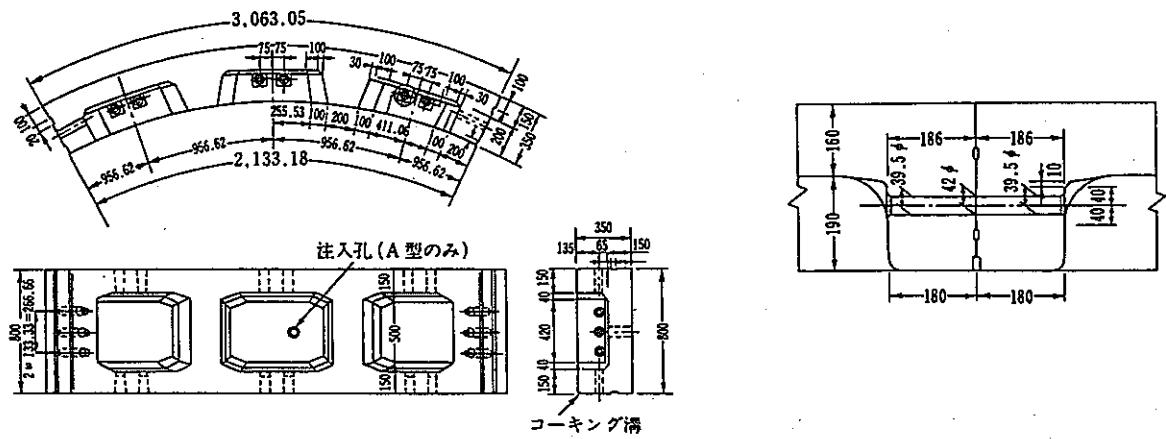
23 直ボルト継手（鉄筋コンクリート箱形セグメント）
